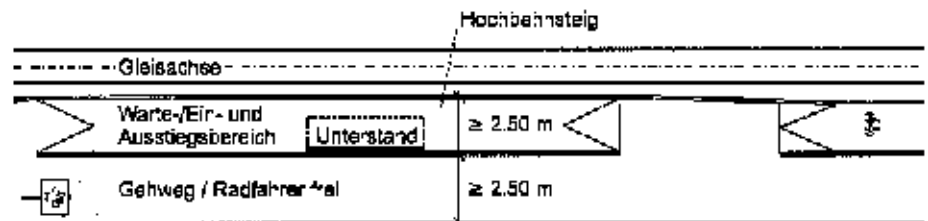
Umfahrung einer Haltestelle mit Hochbahnsteig
